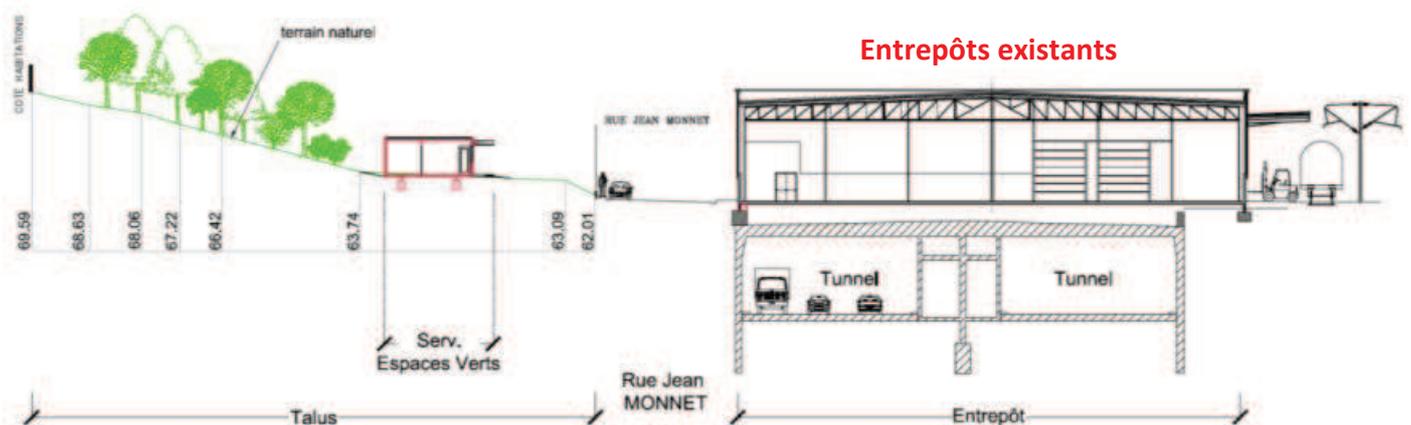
Coupe de principe au niveau des entrepôts ERVAL, issue du plan schématique transmis par la ville
